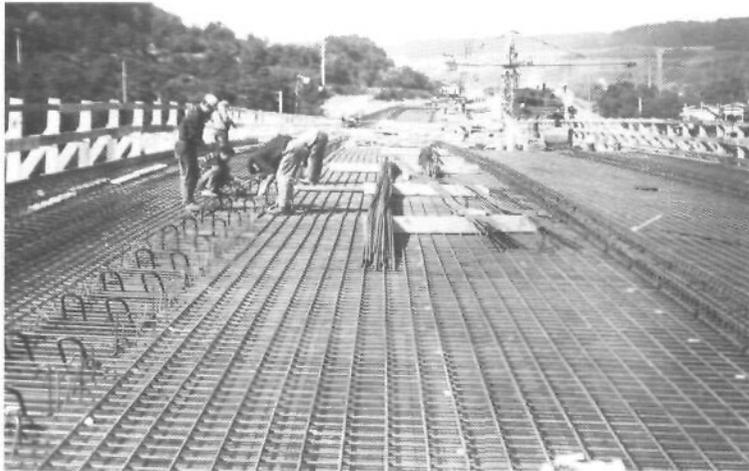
Ferraillage d'un hourdis. Les connecteurs à boucle sont soudés à la membrure supérieure des poutres.
